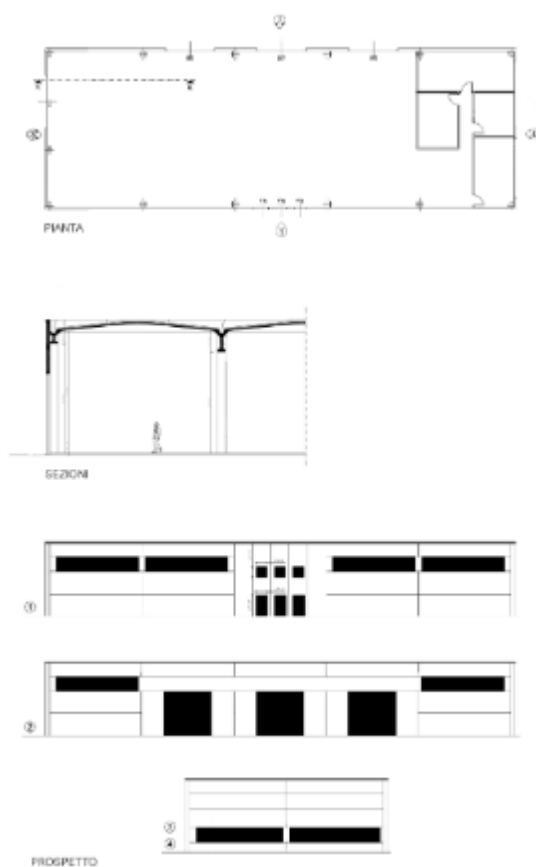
(Dall'alto) pianta, stralcio di sezione, prospetti
